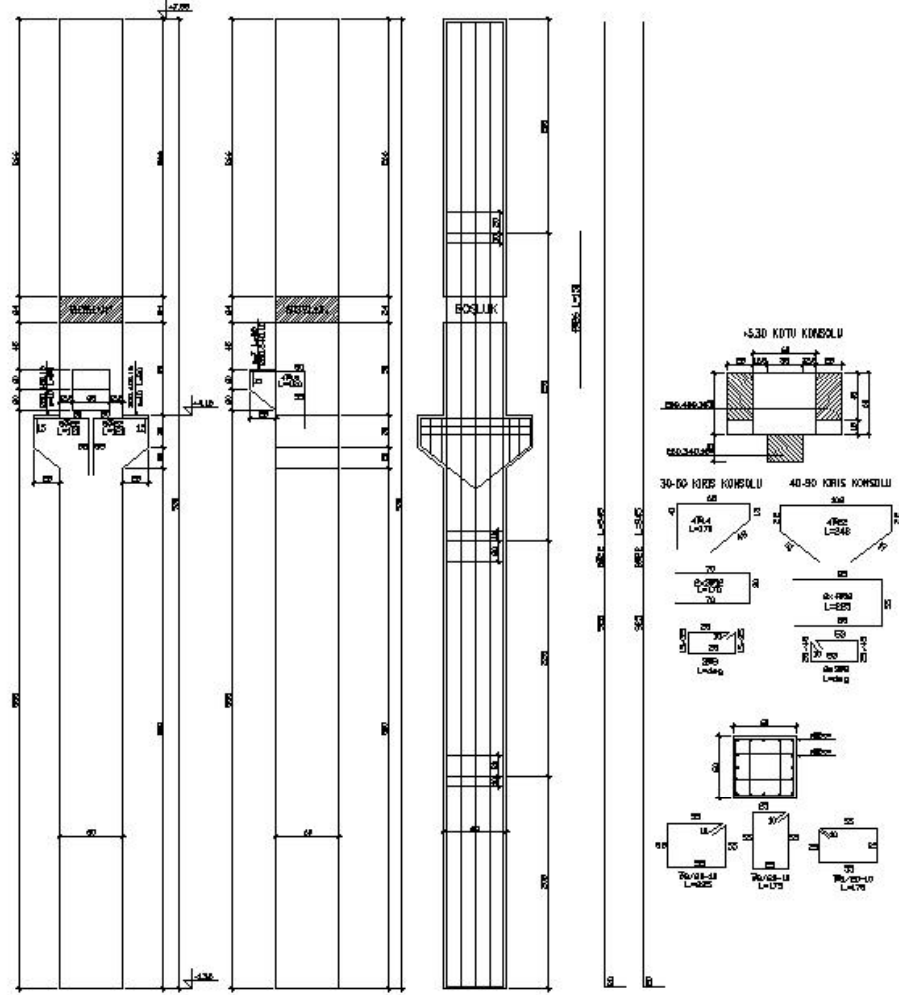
Prefabrike sanayi yapısı S1B kolonu detayı
